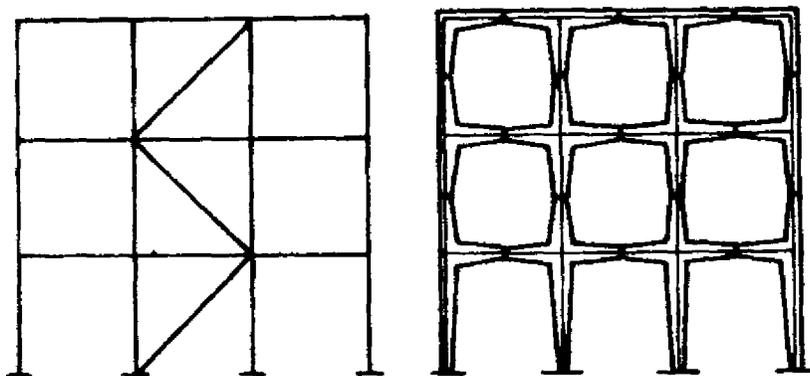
Sistema de marco con elementos precolados (Wakabayashi, 1986).
